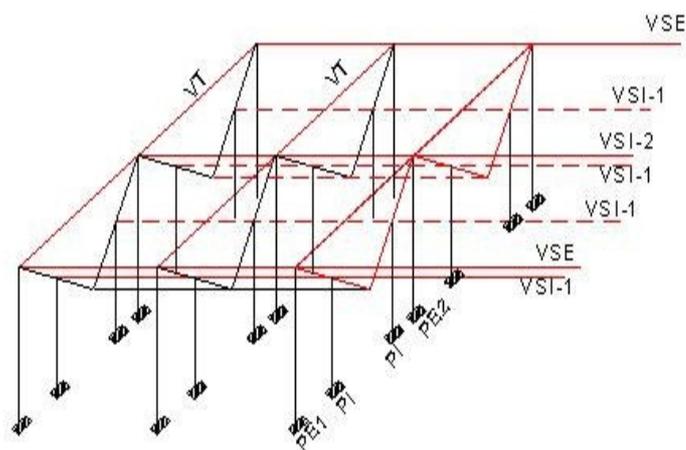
Visão espacial do pórtico. Tri-dimensional frame view.
